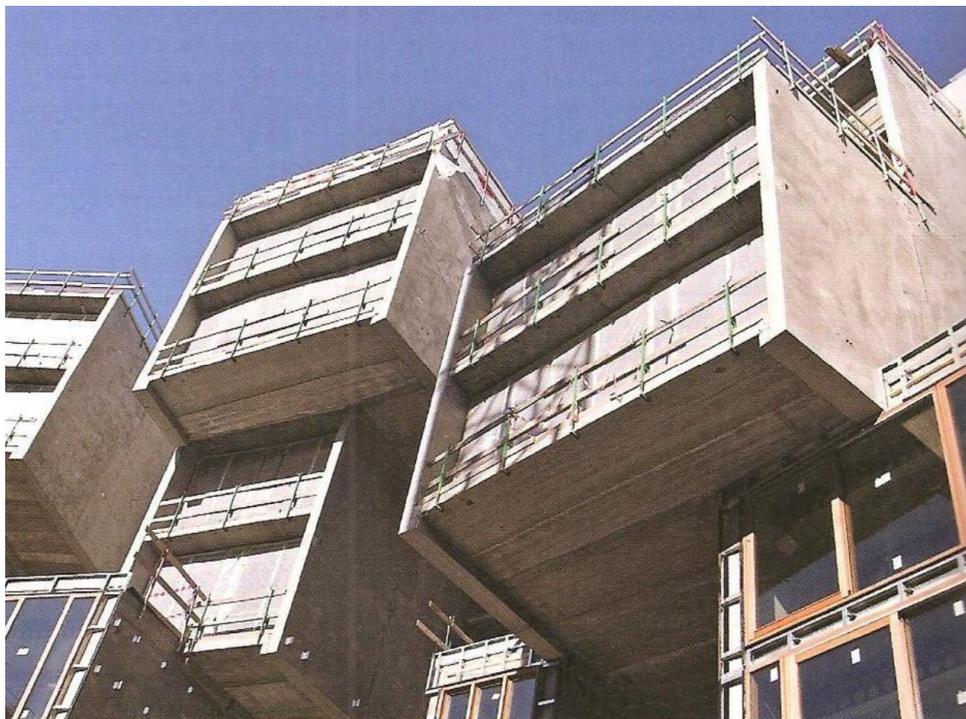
Construção em blocos modulares de dois pavimentos
